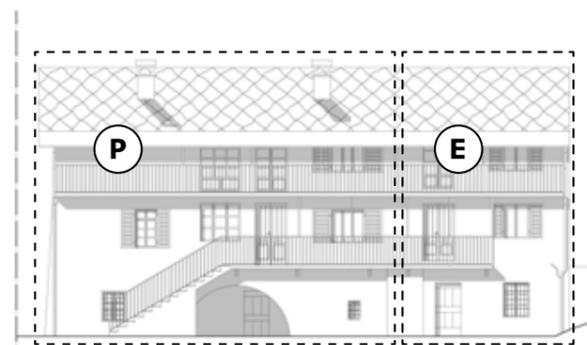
Rappresentazione del prospetto Sud dell'edificio n.8
